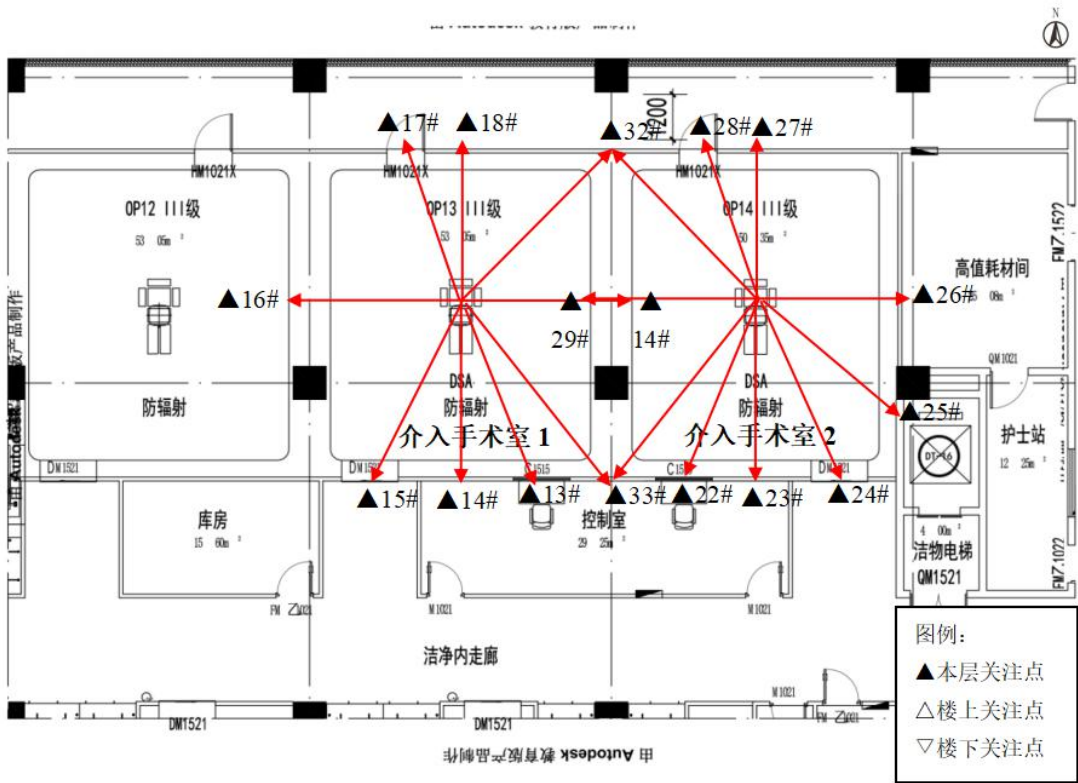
介入手术室 1 和介入手术室 2 平面关注点示意图
